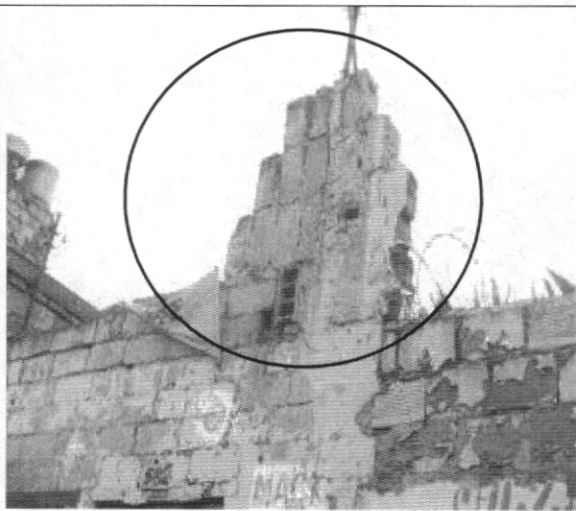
Unidades de mampostería sueltas en la parte central superior del muro.
